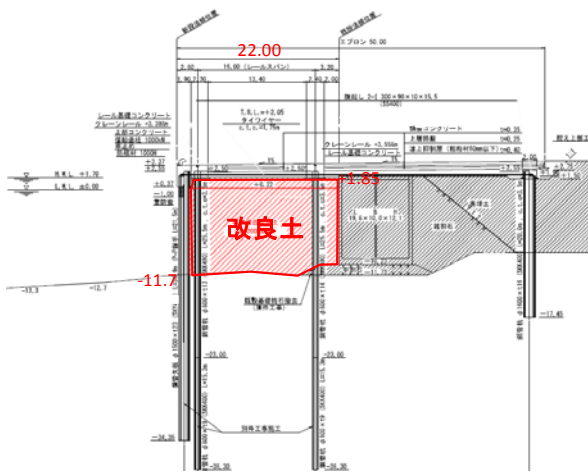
東港区岸壁-12.0m (耐震) 標準断面図
